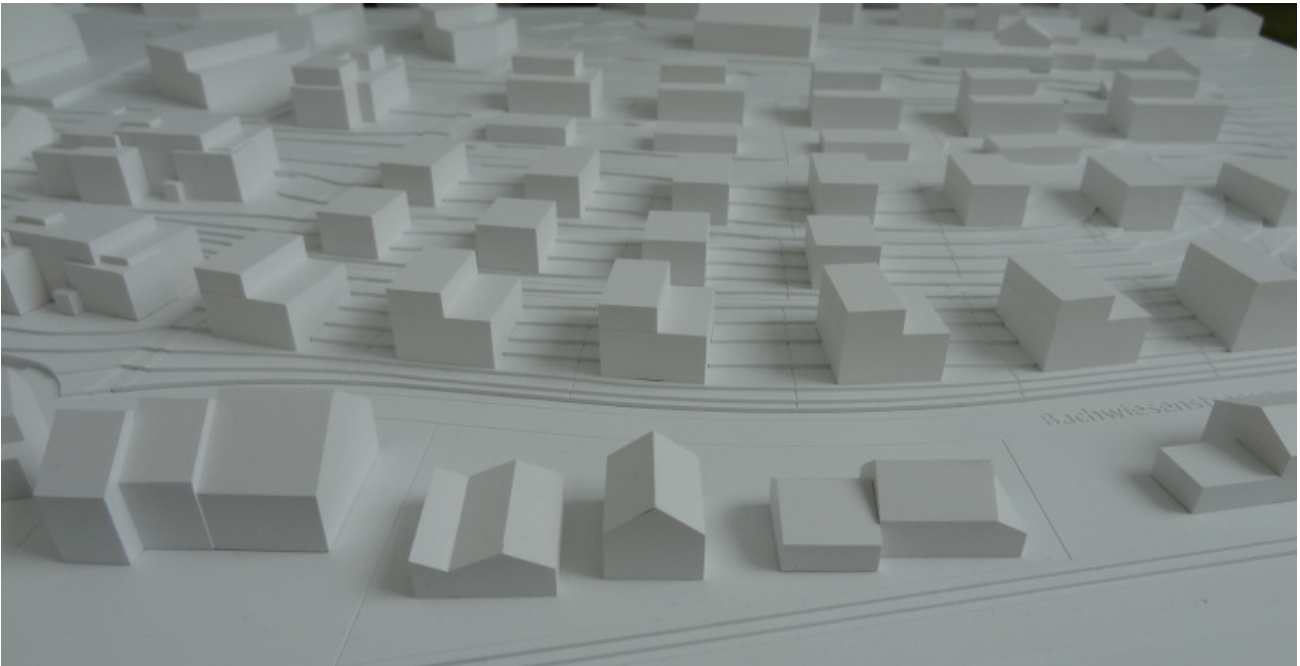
Modelfoto Referenzprojekt Walker Architekten AG, Projektstand 02.2012
